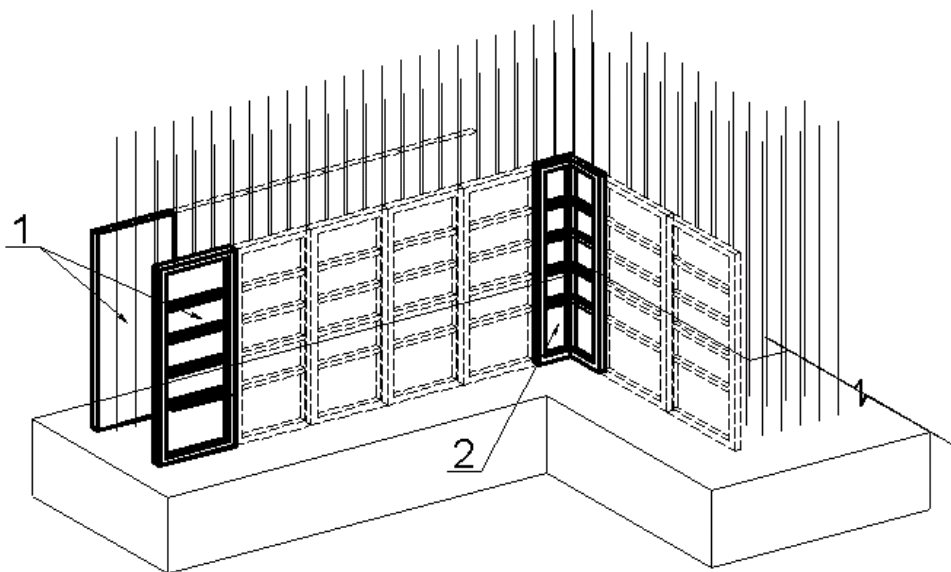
Установка угловых и крайних щитов опалубки. 1 – крайний щит, 2 – угловой щит.
